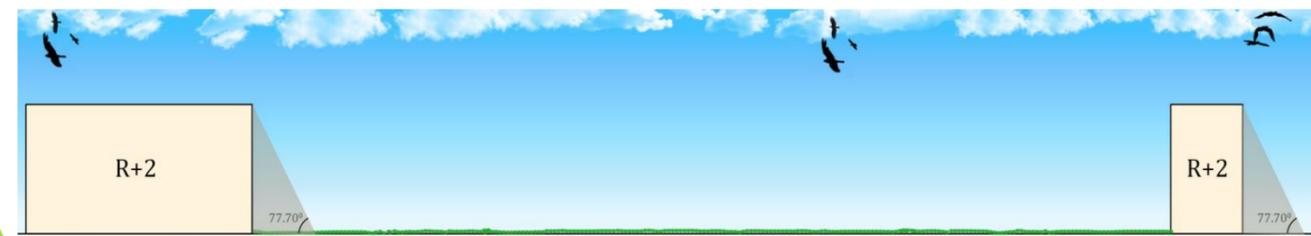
Coupe BB' ( sur rue secondaire) (Source : Auteur)
